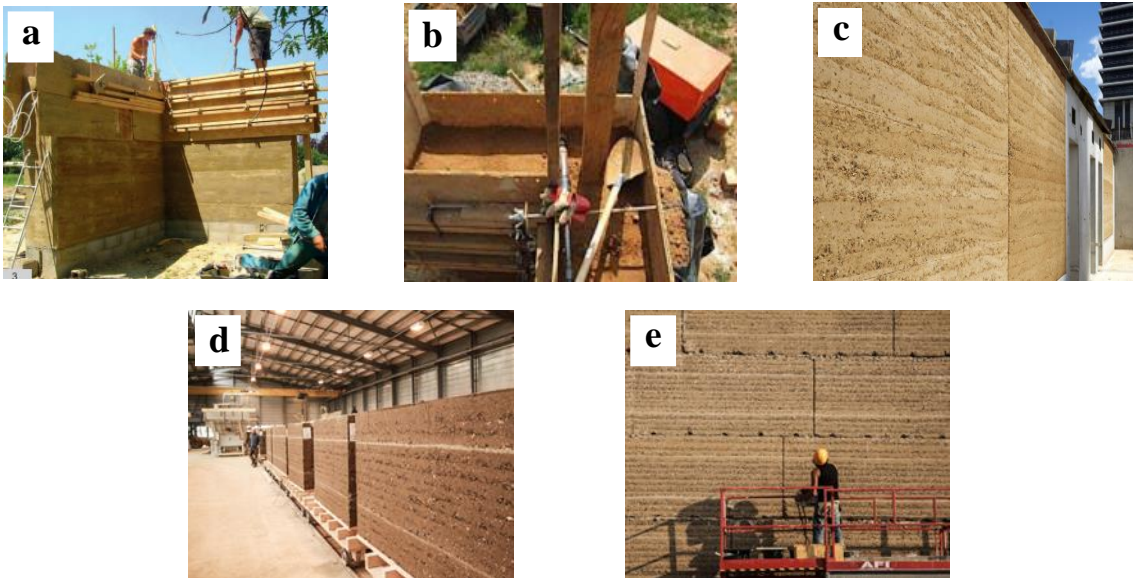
(a) et (b) Construction d'un mur en pisé fini, (c) Exemple d'un mur en pisé (d) préfabrication de panneaux de pisé en atelier et (e) assemblage de panneaux de pisé préfabriqué sur chantier [Hibouche, 2013]
